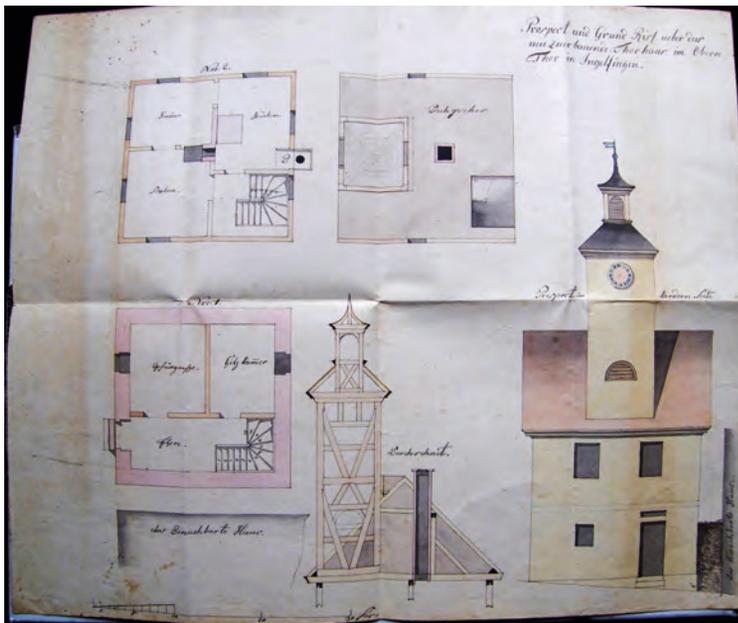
Grundriss des Oberen Torhauses, Entwurf des Zimmerermeisters Georg Schillinger 1832
